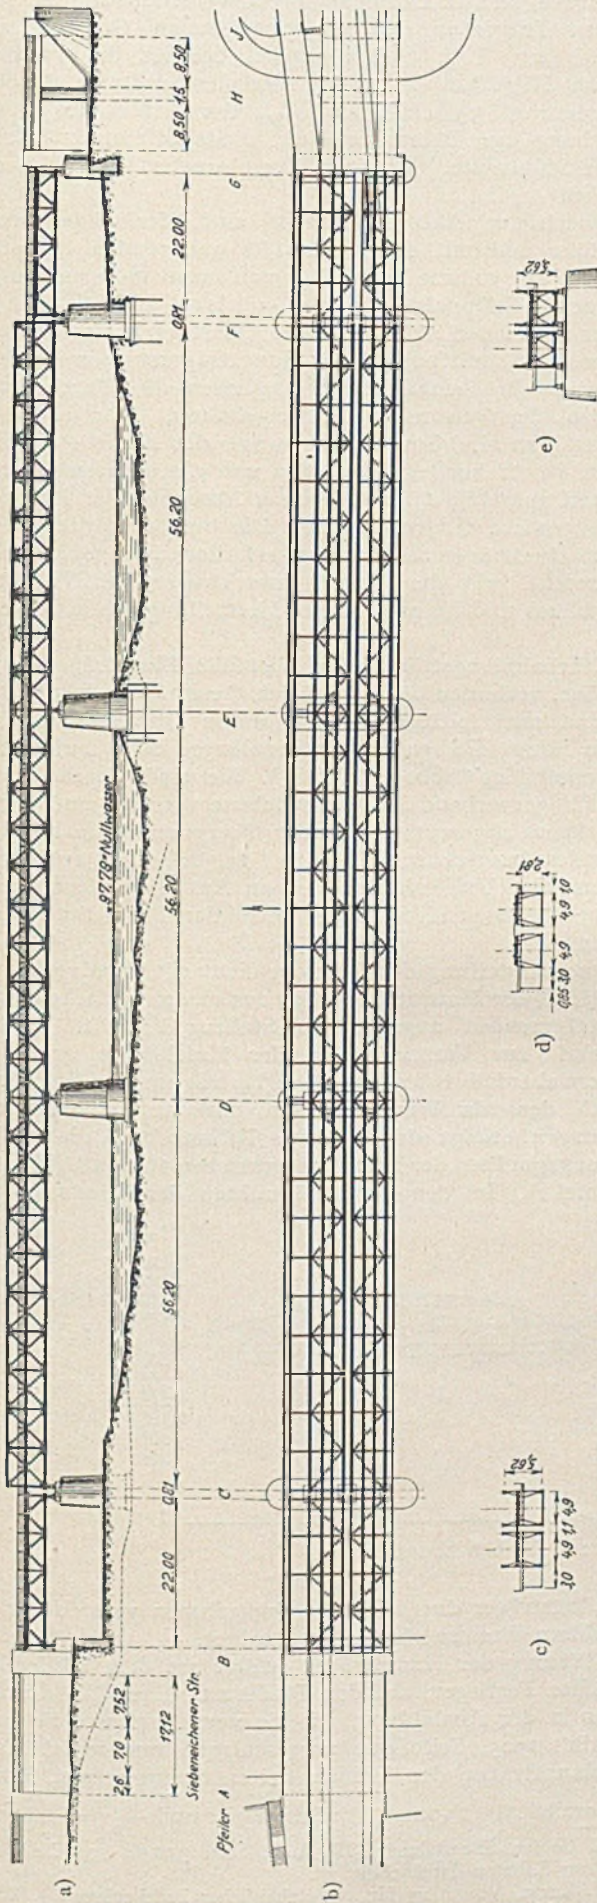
Erster Entwurf Tessenow für die Unterführung der Siebeneichener Straße.
